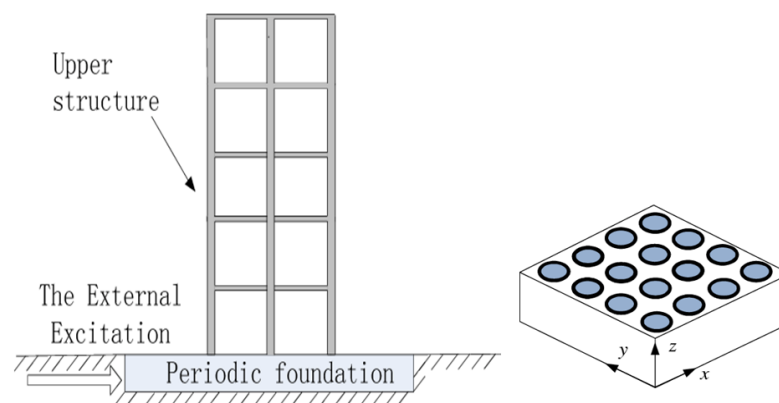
Schéma d'une structure sur une fondation à périodicité bidimensionnelle [133]
